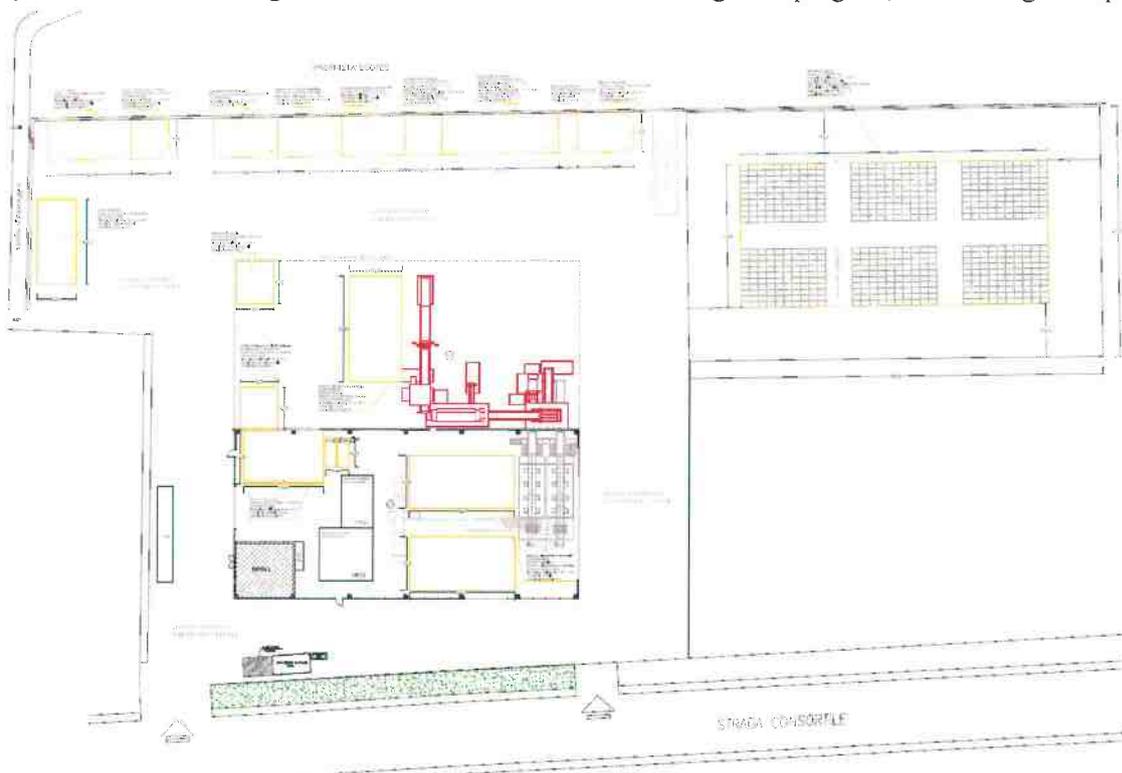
Nuovo layout impianto (stralcio TAV 1f)
